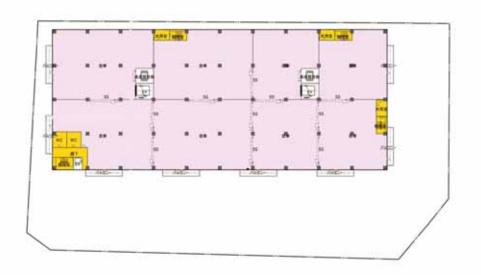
(2) 計画建築物平面図 (46-2街区 2~3階)
